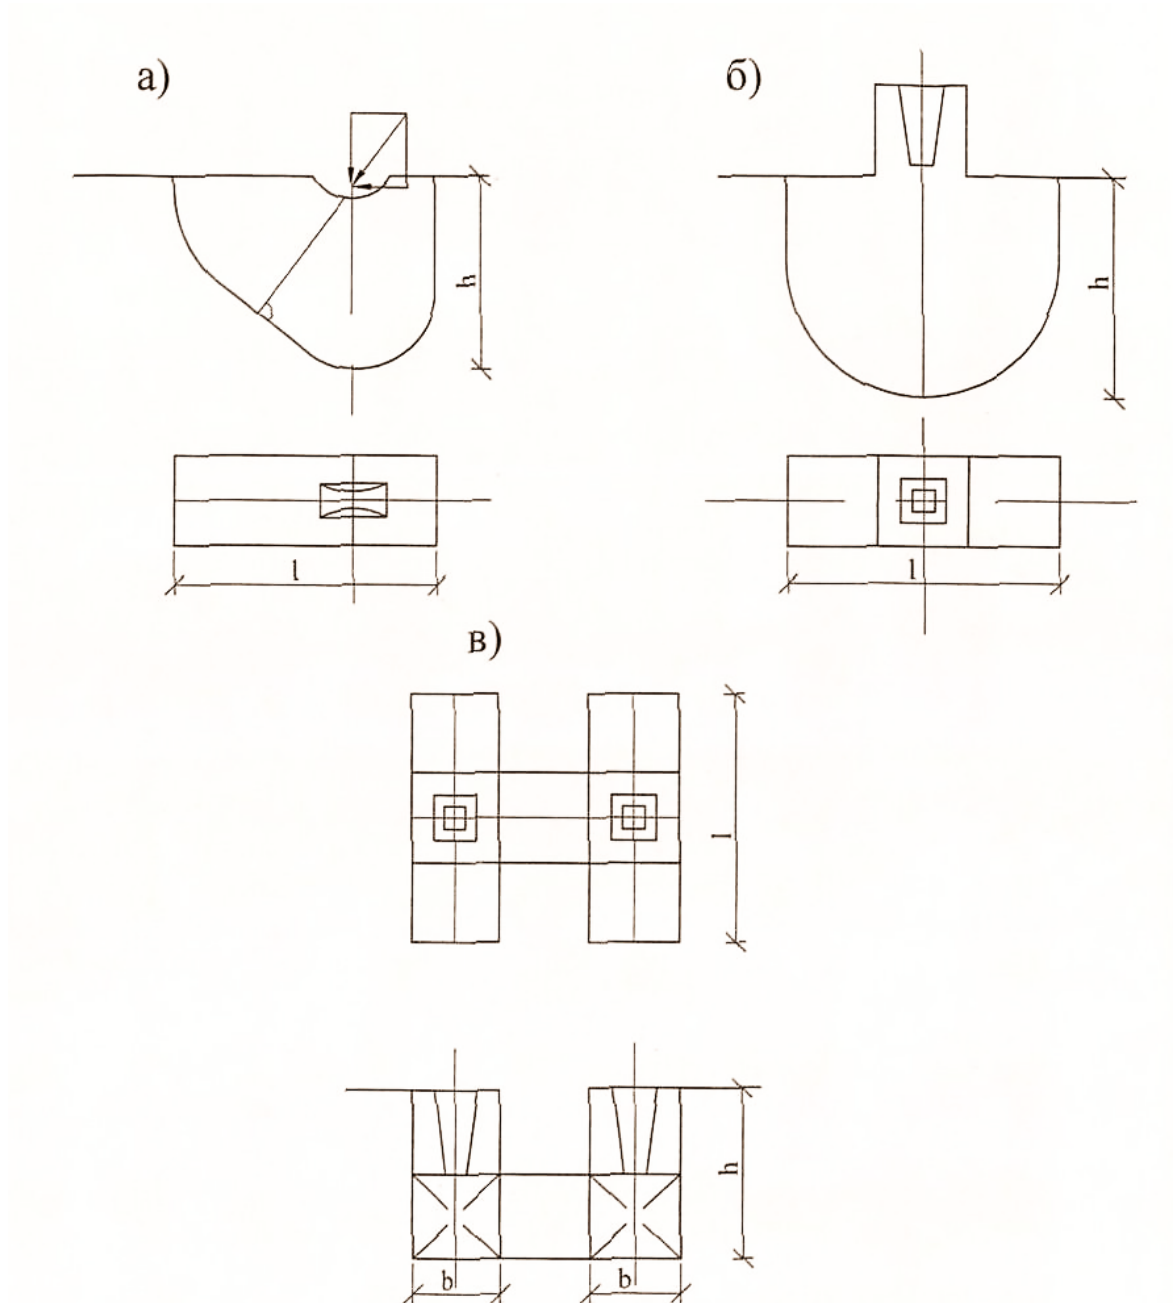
Монолітні фундаменти з робочою поверхнею:
